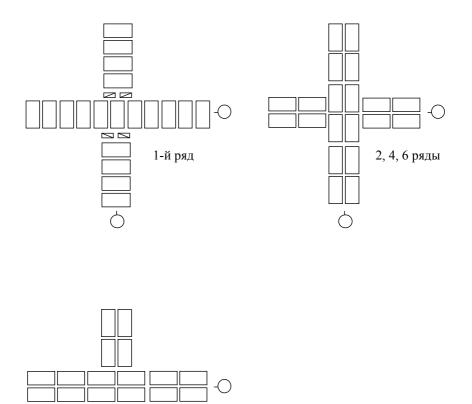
Кладка пересечений стен толщиной в 1 кирпич
